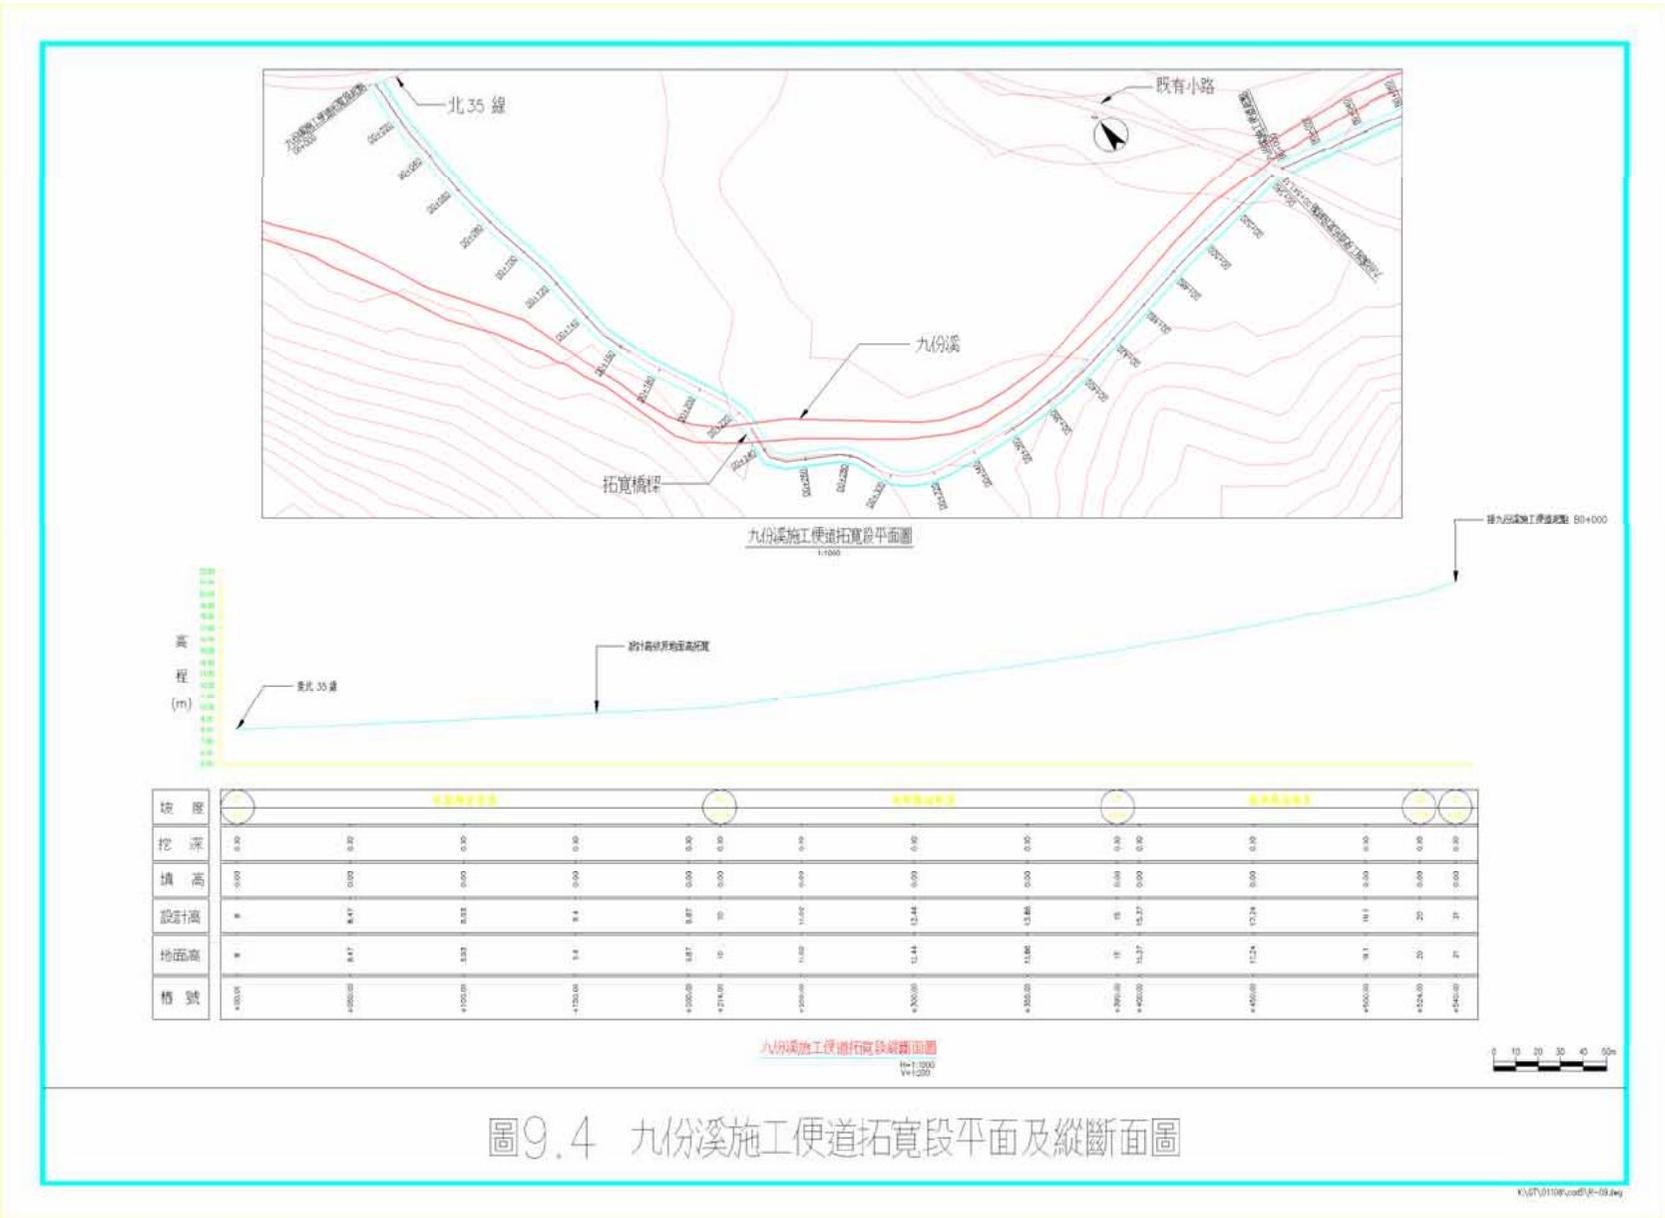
九份溪施工便道拓寬段平面及縱斷面圖
